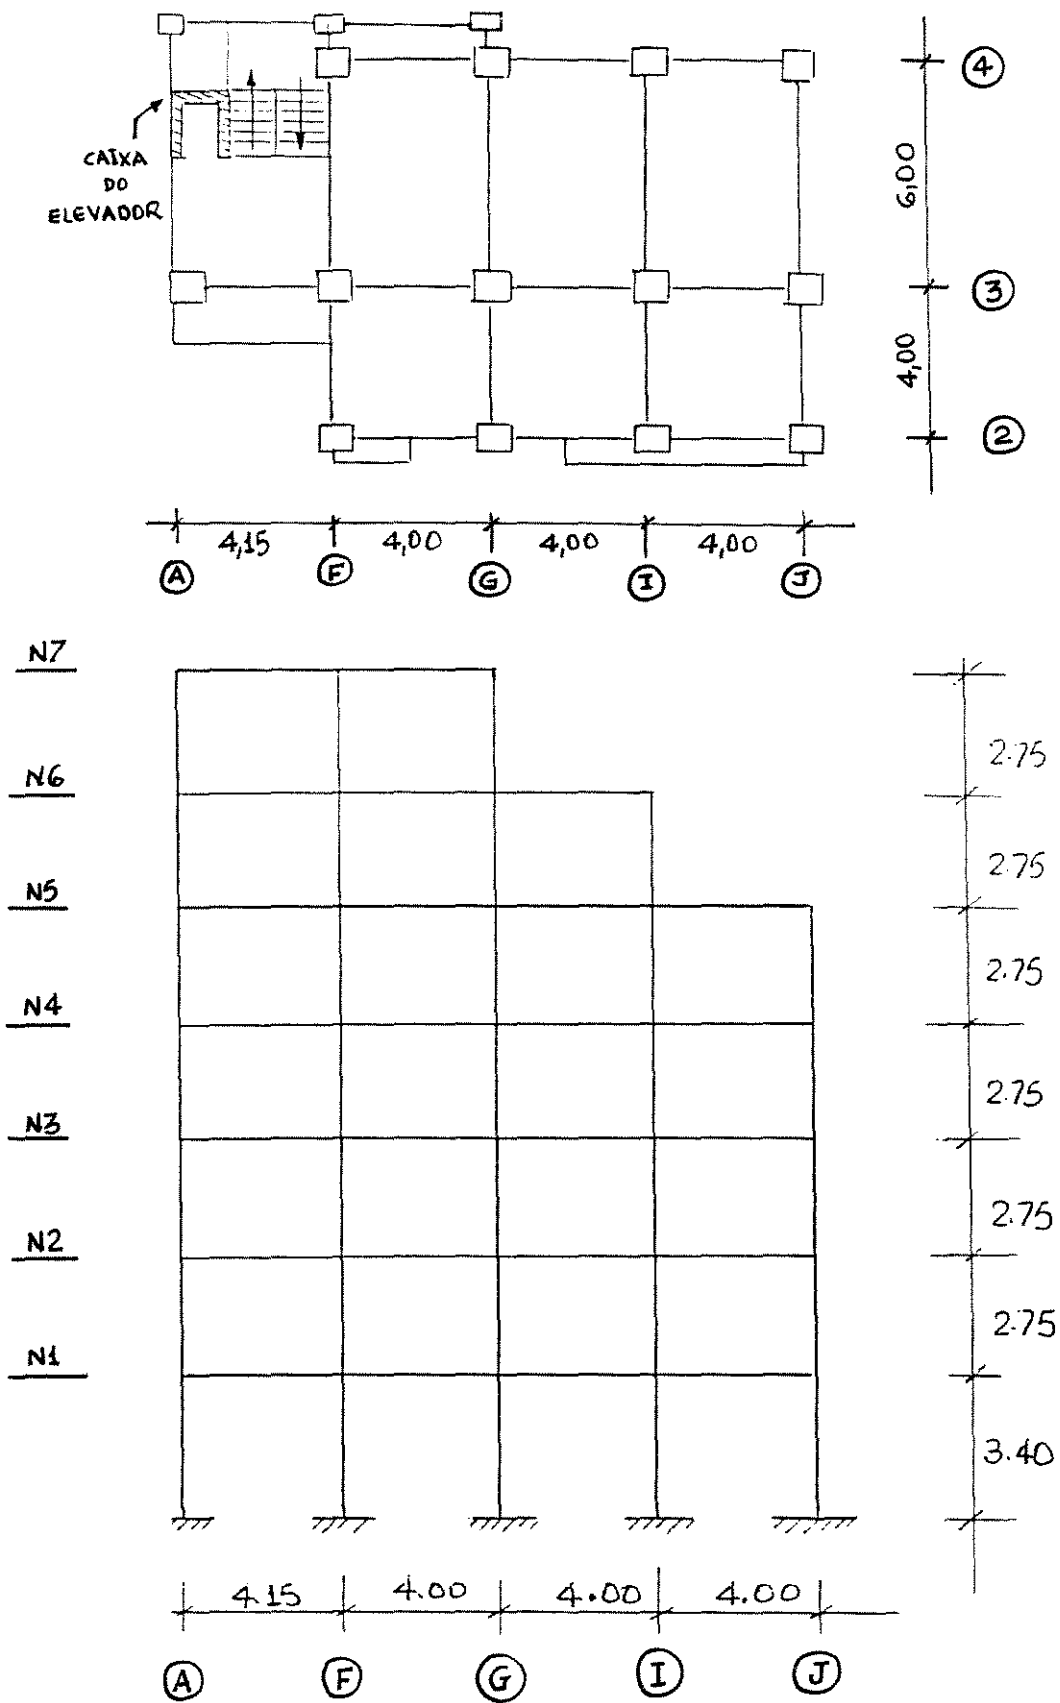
Planta e elevação da edificação de 7 andares do exemplo 2.
